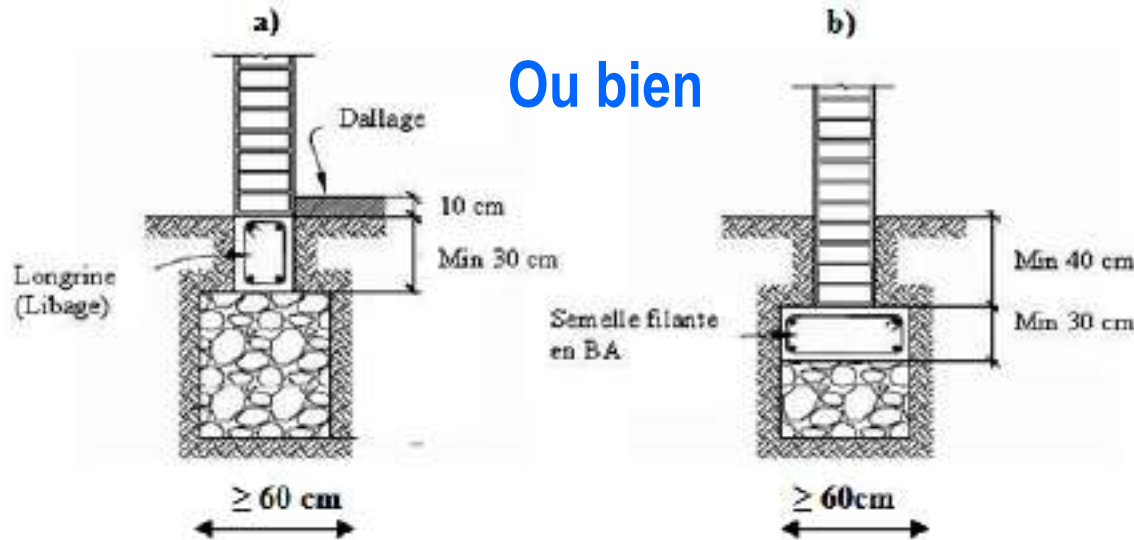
Fondations: a) Fondation en maçonnerie de pierres et longrine en BA; b) Semelle filante en BA
